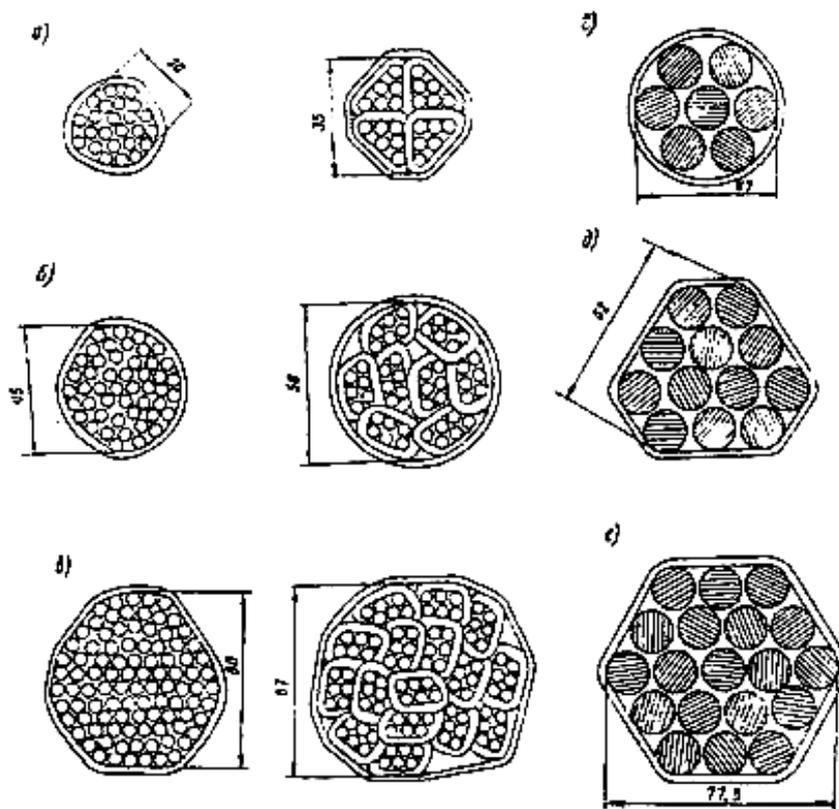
Поперечное сечение пучков из проволок и прядей:
